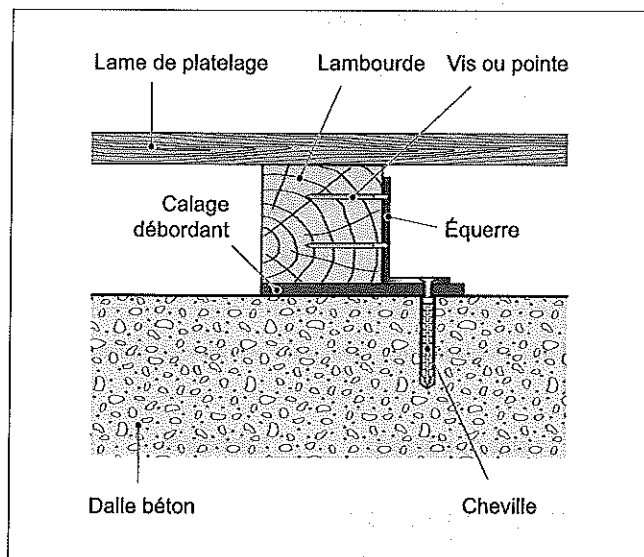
Fixation d'un platelage avec lambourdes sur support en béton – Fixation directe par chevilles (source : DTU 51.4).
